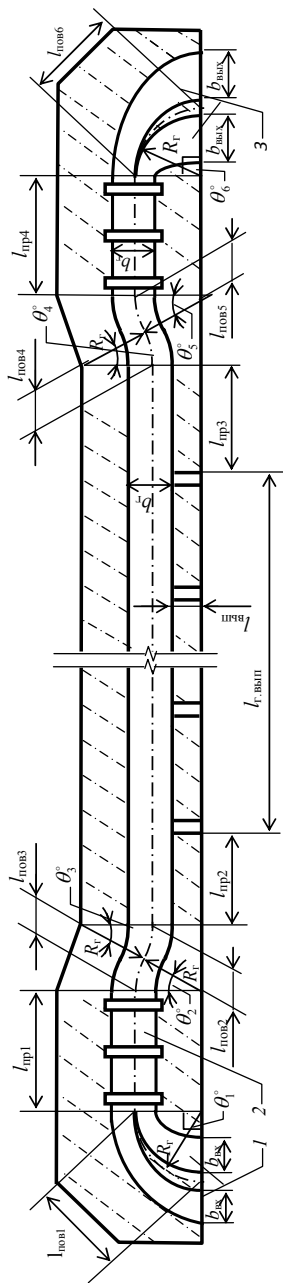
Расчетная схема распределительной системы питания с галереями в стенах камер:
